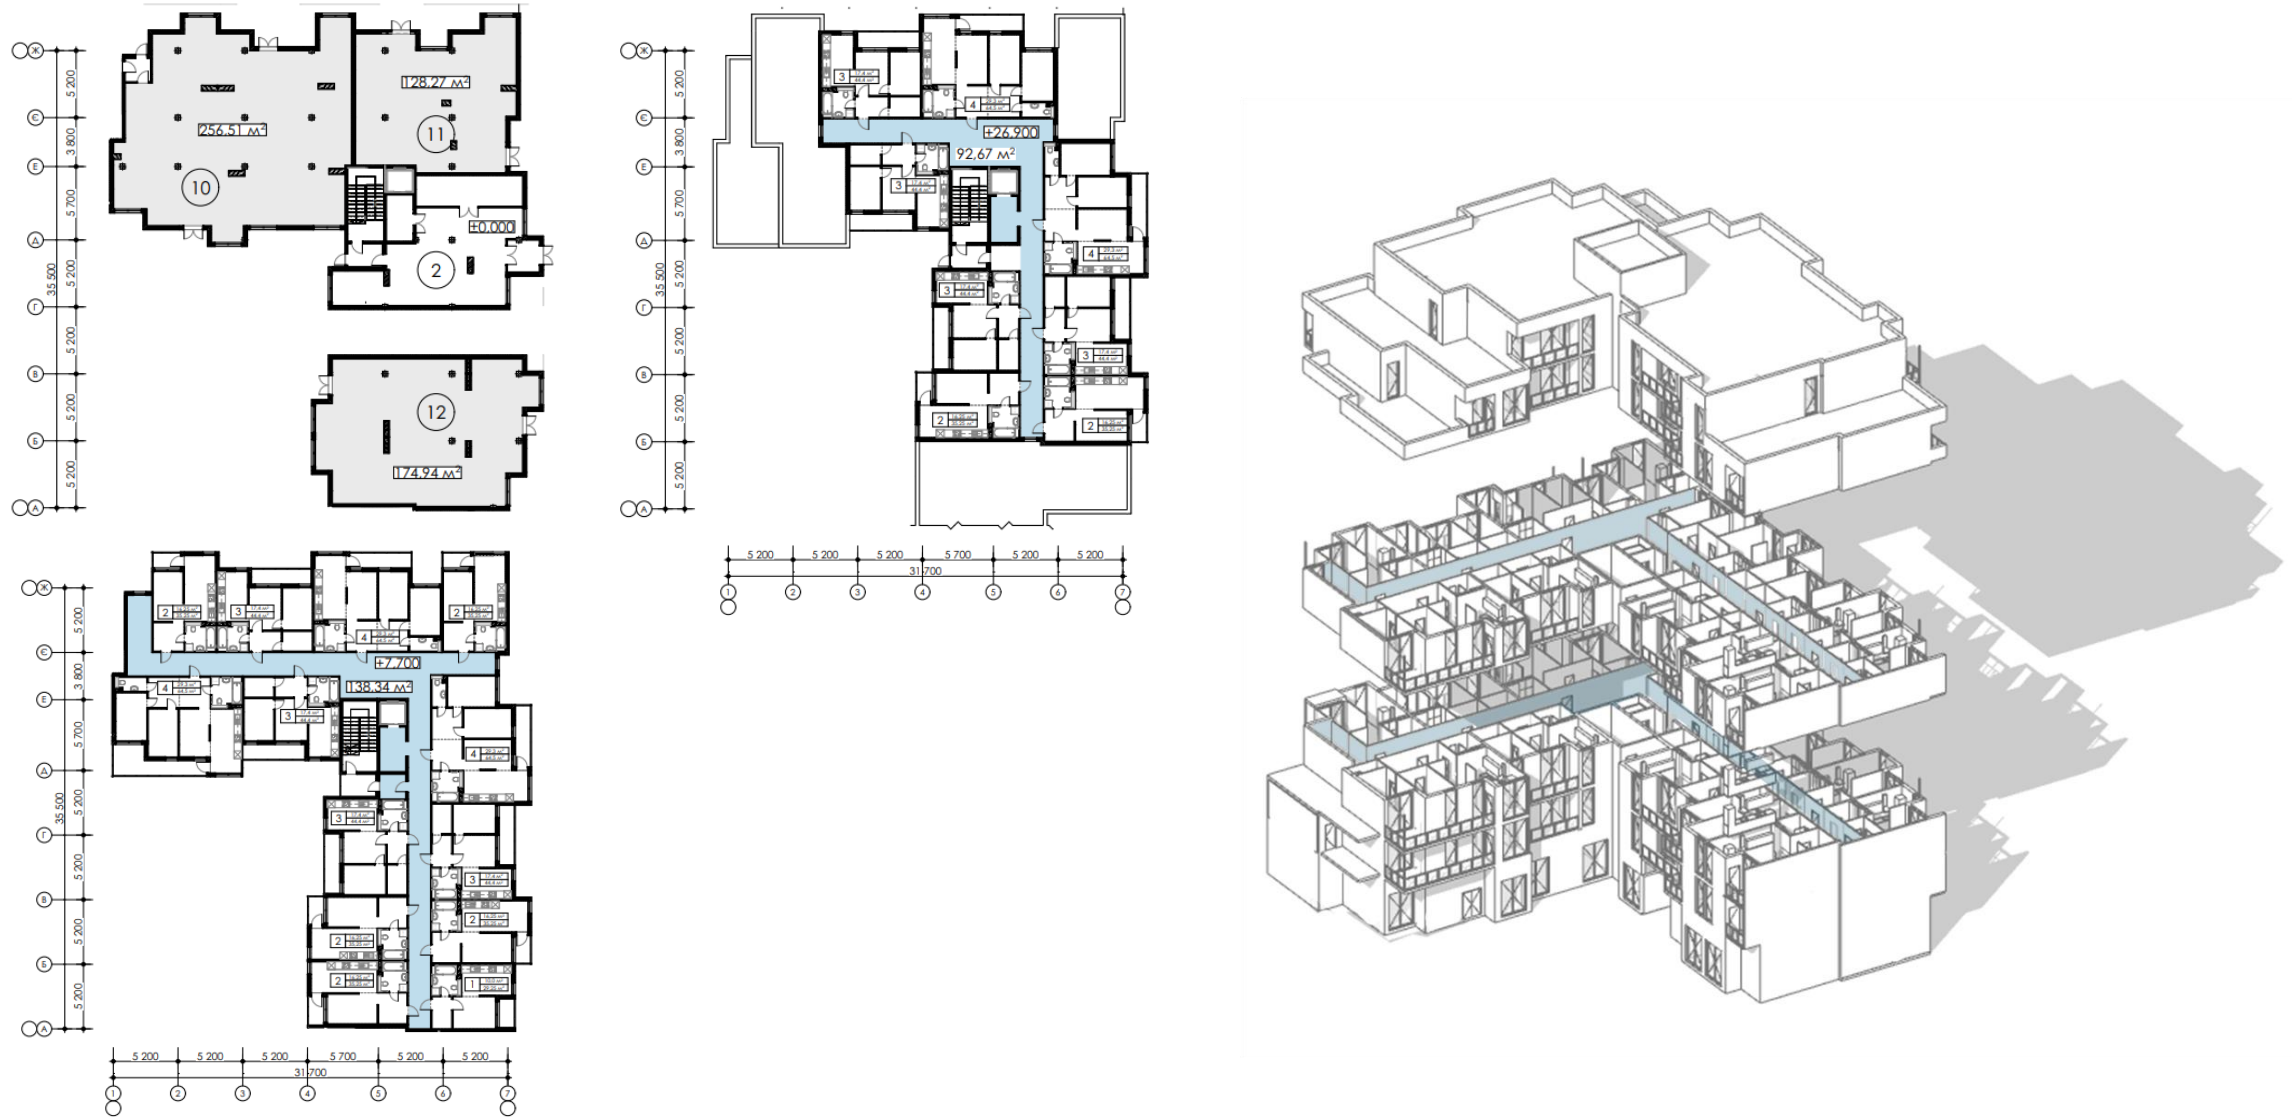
Планування та конструкція секції Г-Г'
